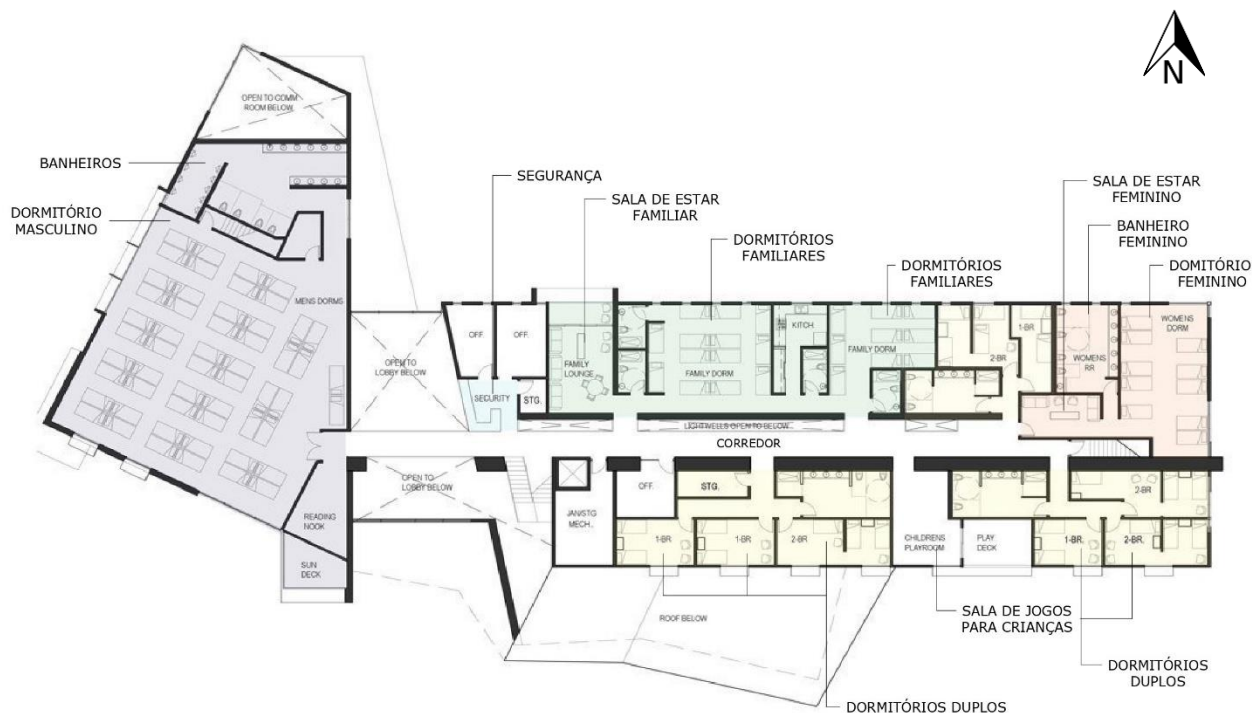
Planta Baixa- Pav. Térreo CAPSLO
